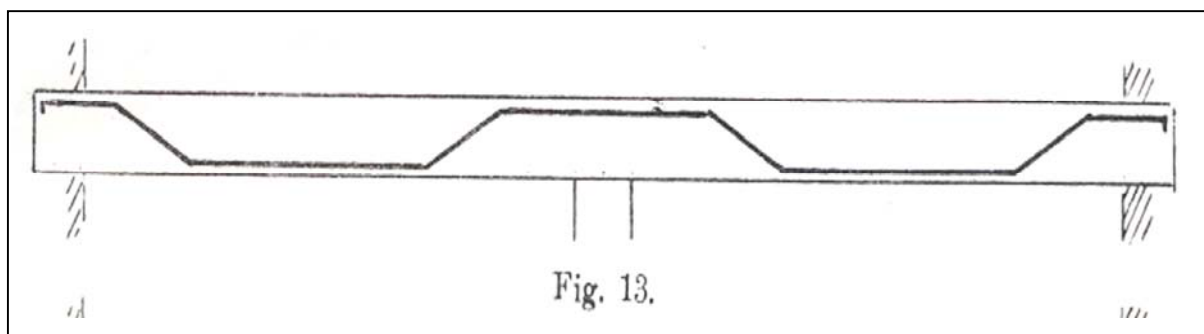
Bewehrungsführung in Stahlbetonplatten nach [Haberstroh – 1908]
